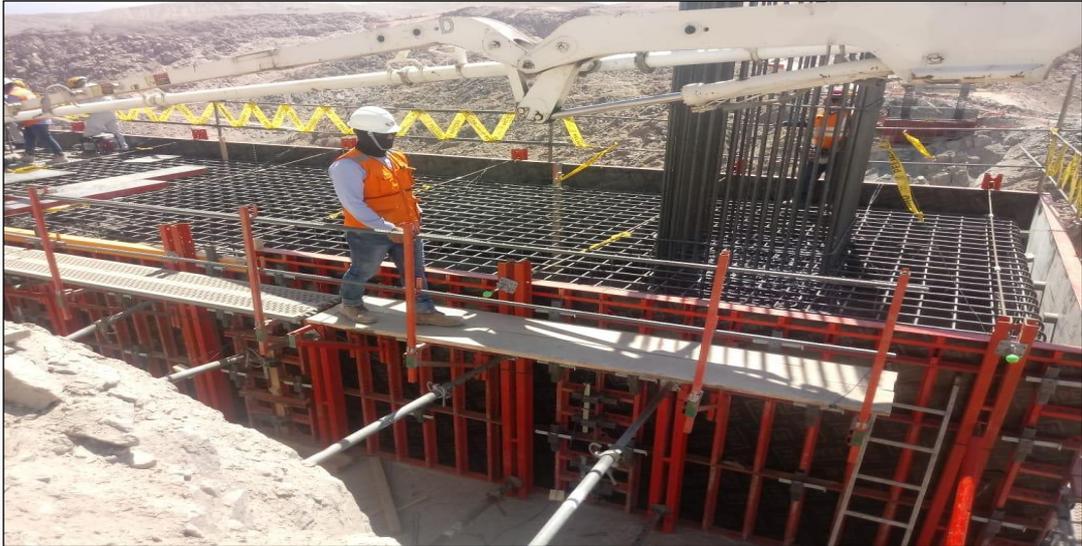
Colocación de acero y encofrado en zapata de pilar 10 posterior a la terminación de los pilotes
